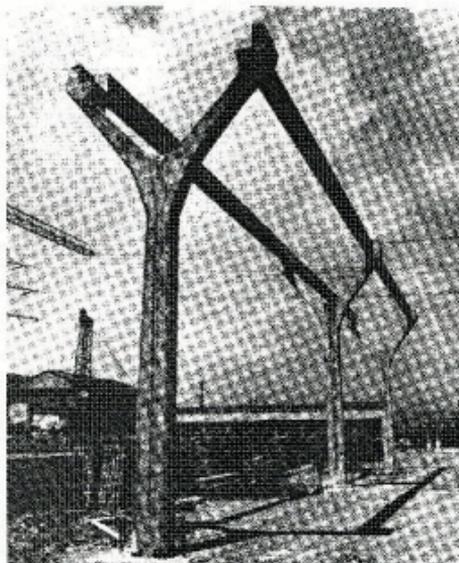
Pilares en "Y" de la estructura del tren vertebrado.
